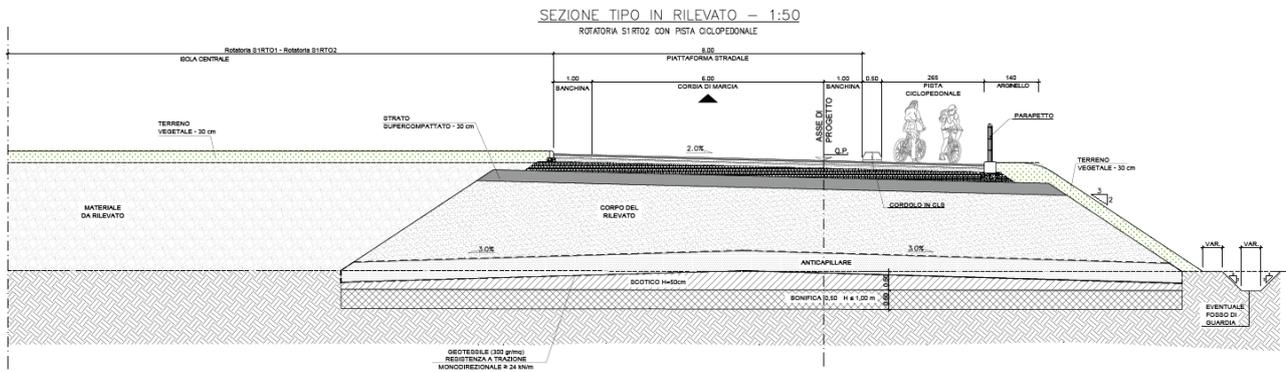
Sezione tipo S1RT02 con pista ciclopedonale
